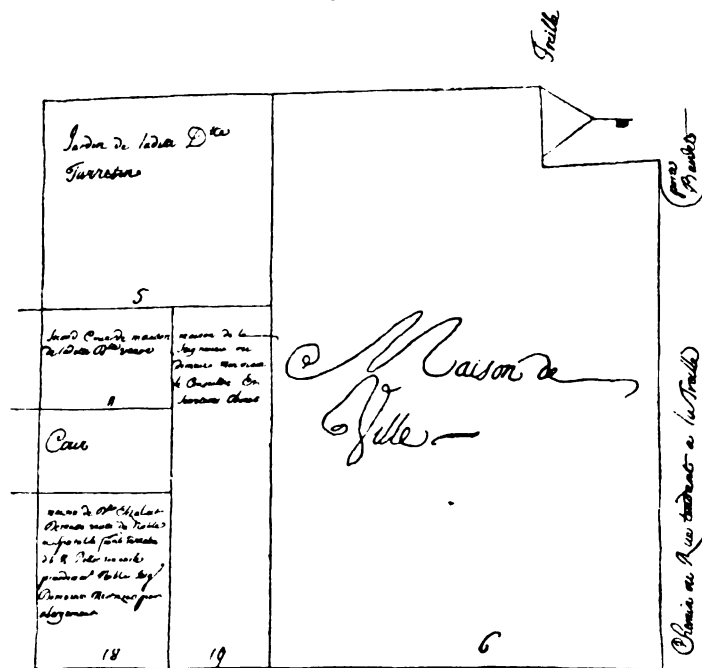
Plan de la Maison de ville au XVIII^e s., d'après les Anciens plans de la ville.
